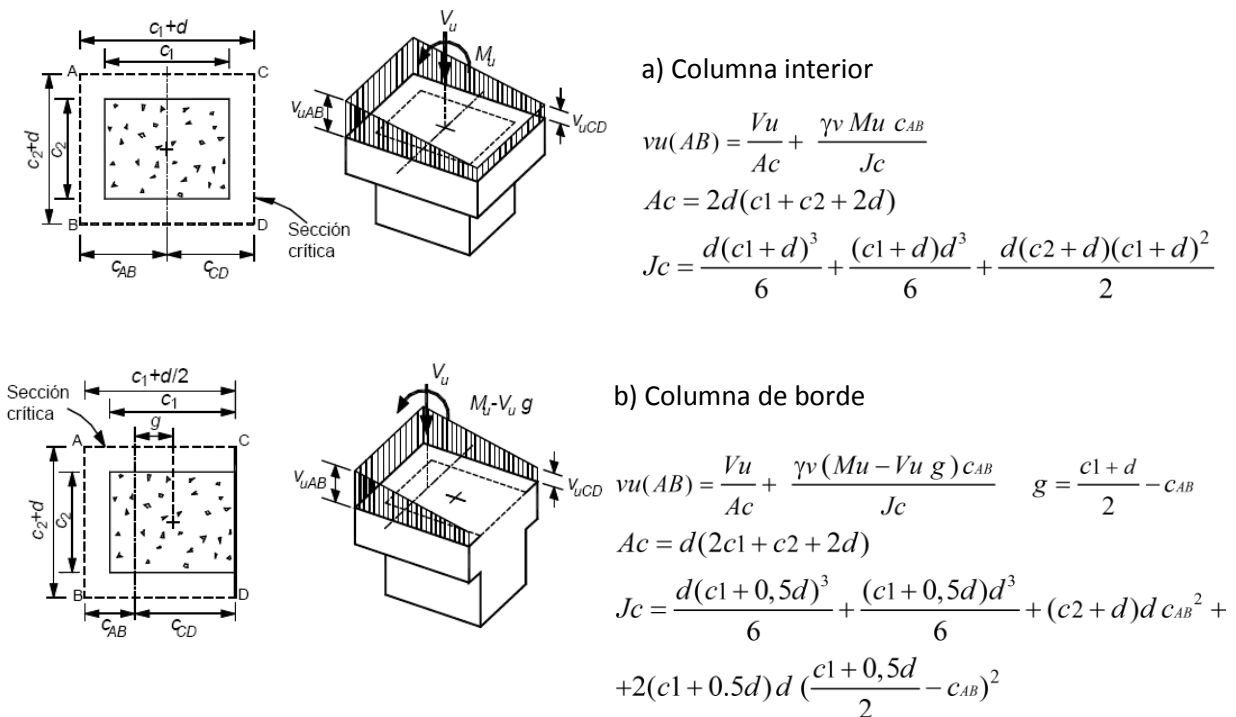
Distribución de los esfuerzos cortantes en el perímetro de la sección crítica en conexiones losa a columna
